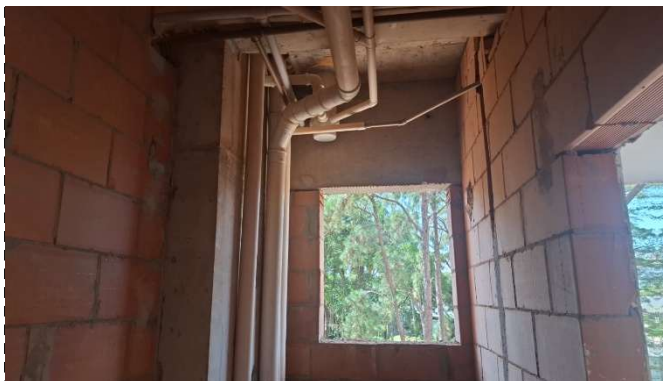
Execução dos ramais de esgoto do apartamento modelo.
